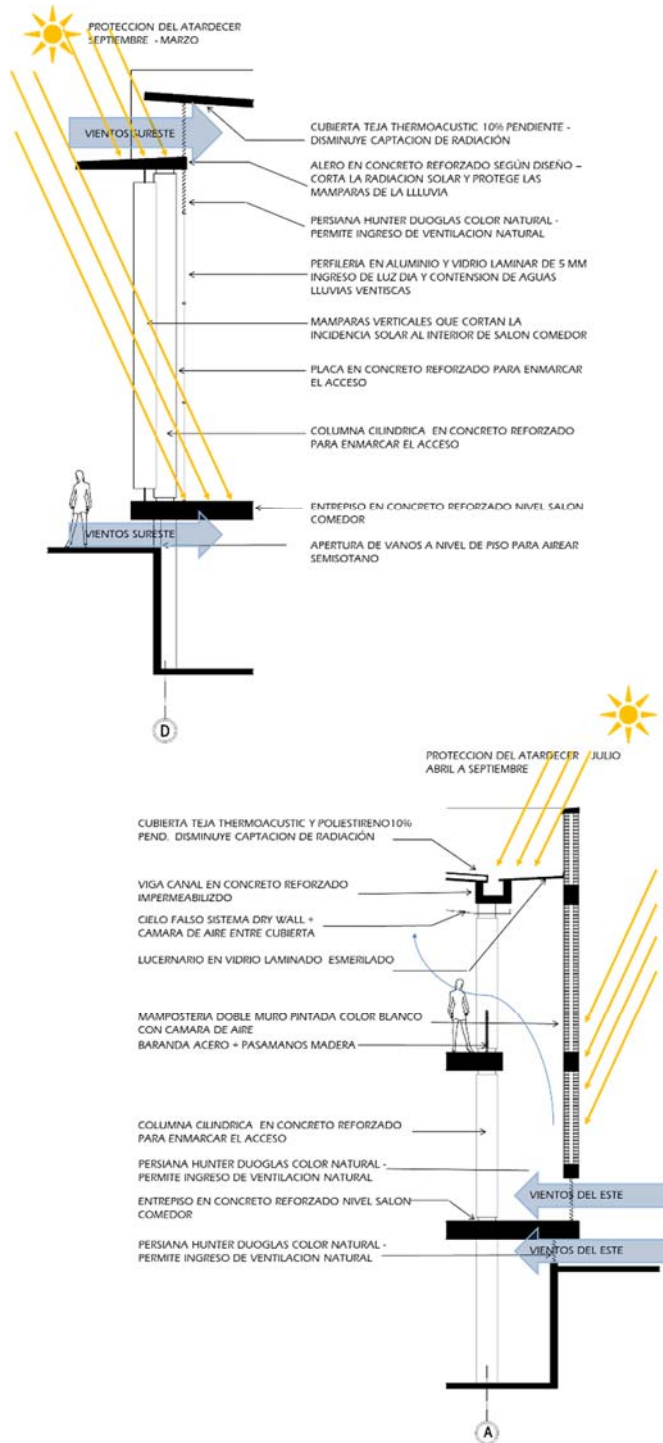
Corte Por Fachada. Fuente: Elaboración propia
